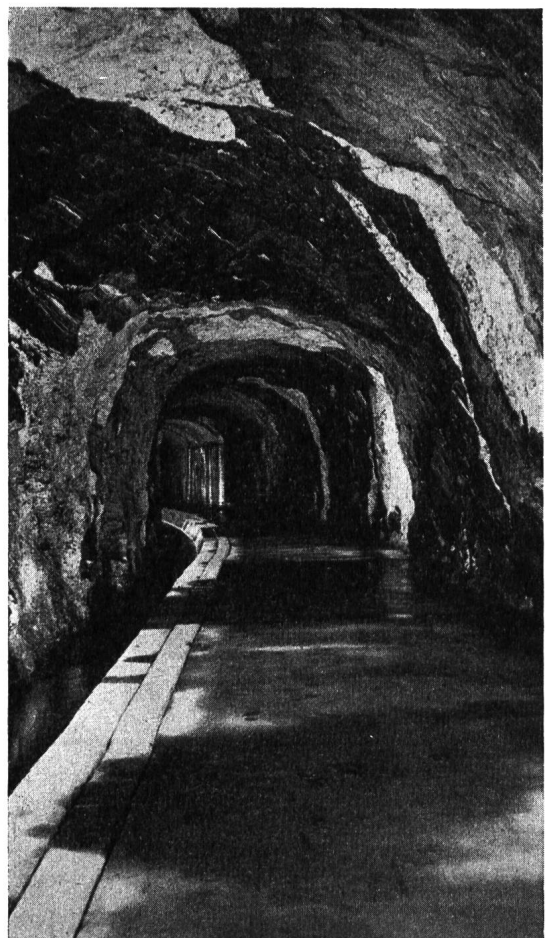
Kraftwerk Verbano, Freilaufstollen mit Betonsohle,
